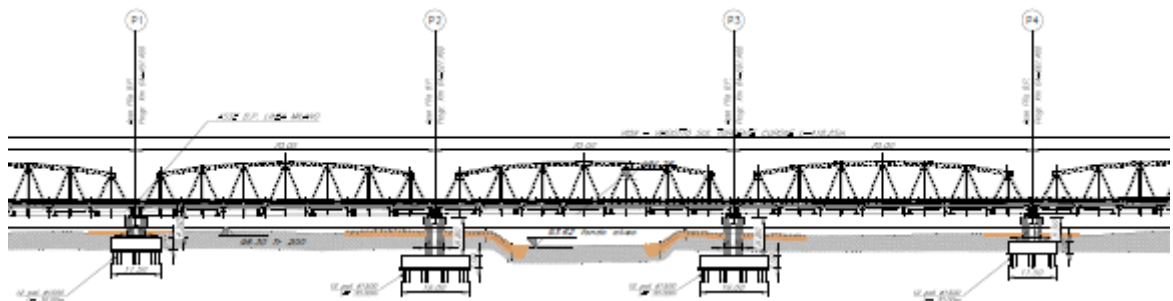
stralcio prospettico viadotto VI09 sul torrente Curone
